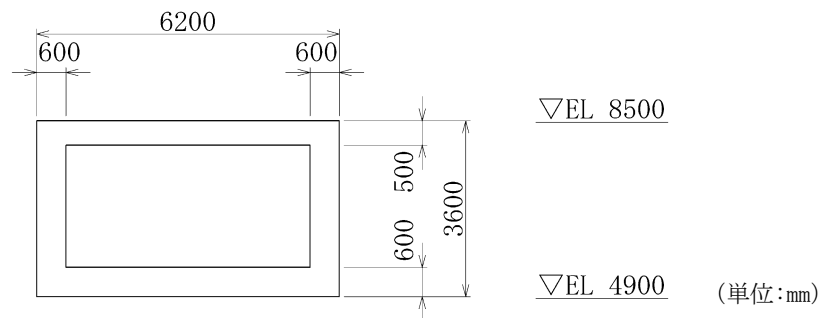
屋外配管ダクト (タービン建物~排気筒) 断面図 (D-D断面)
